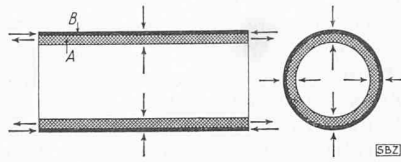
Rohr aus Schwellbeton (schraffiert) in einer Umhüllung
